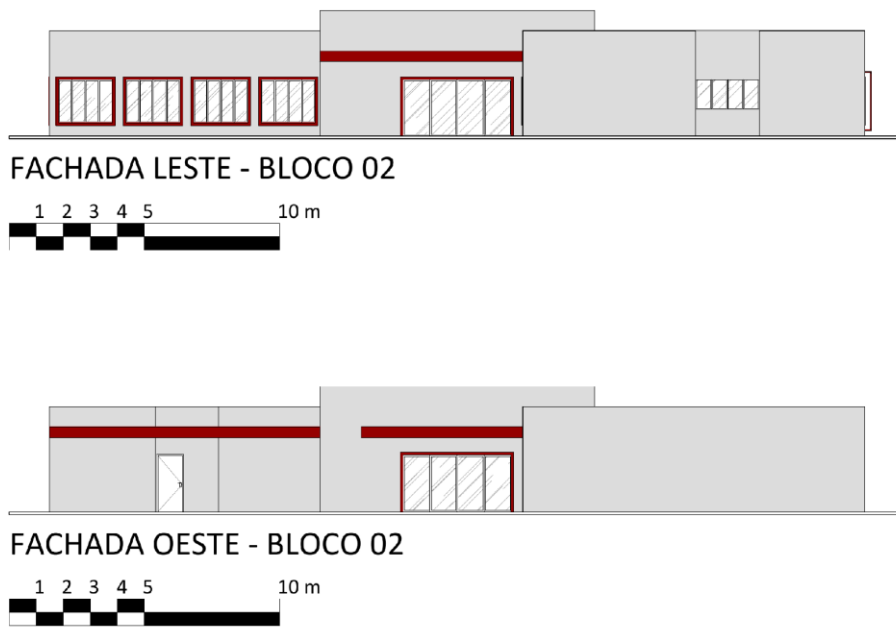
FACHADAS LESTE E OESTE DO BLOCO 02. FONTE: AUTORAL.
